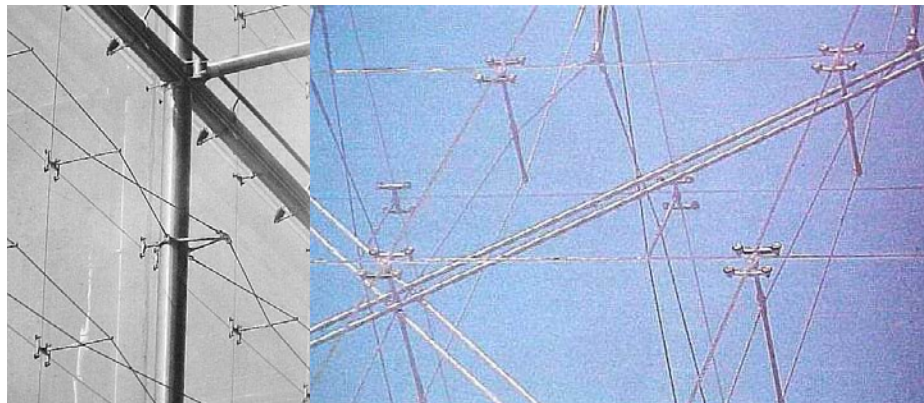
Aspecto del acristalamiento de los invernaderos de la Villette. Su efecto de extrema ligereza ha generado gran interés por las fachadas de vidrio estructural.
